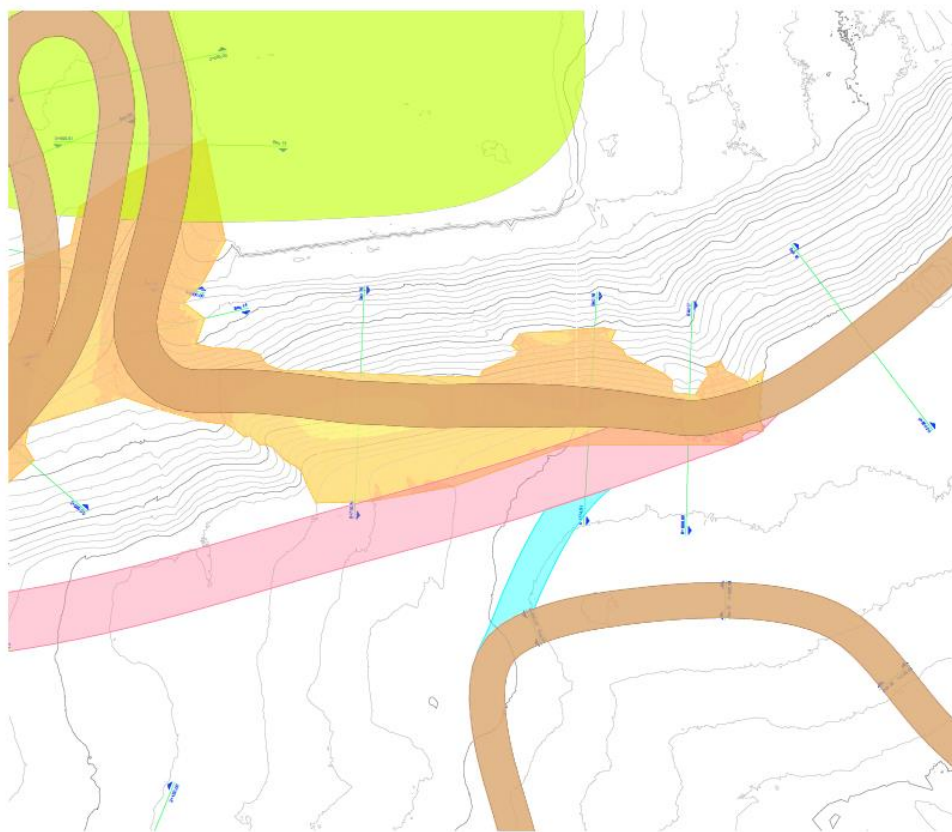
Estratto planimetria sterri e riporti - scala a vista
